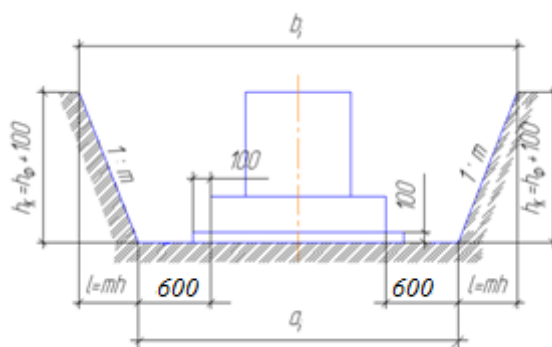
Разрез траншеи с установленным фундаментом.
